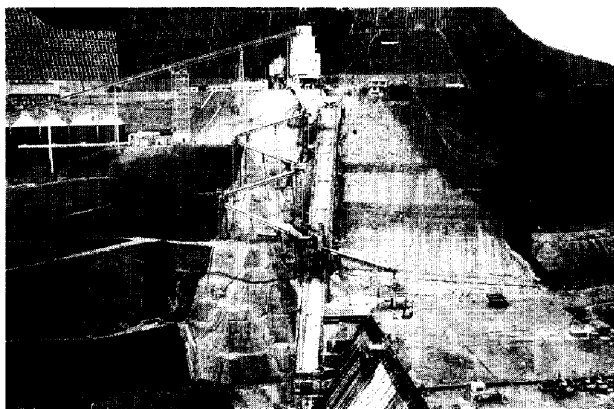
平成7年11月堤体状況 (ベルト延長=285.0m)
